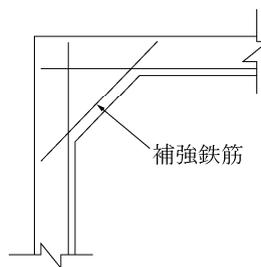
ラーメンのハンチ、内側に沿う補強鉄筋
